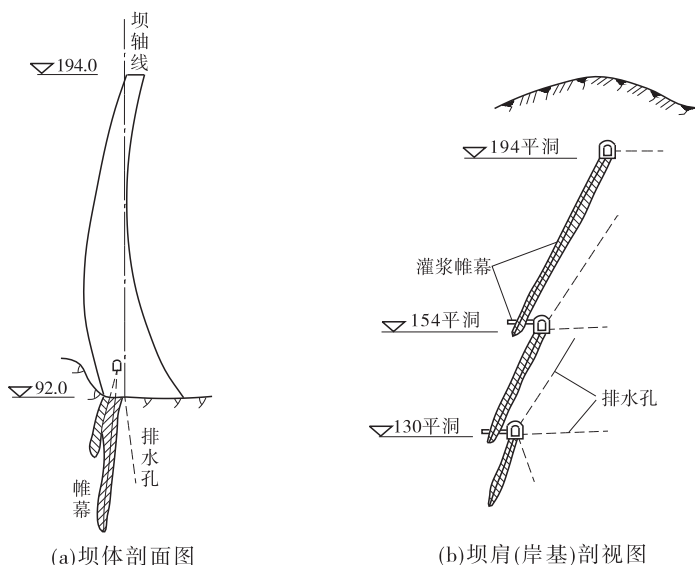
拱坝基岩帷幕灌浆与排水孔设置 (单位:m)
